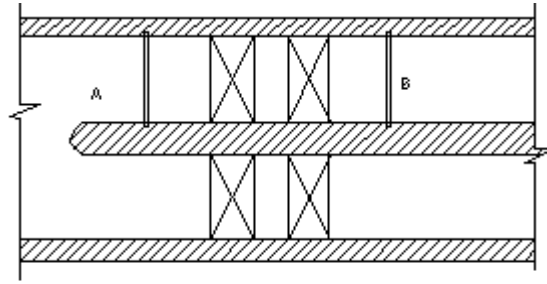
Planta del cierre del desvío si existe desagüe de fondo
